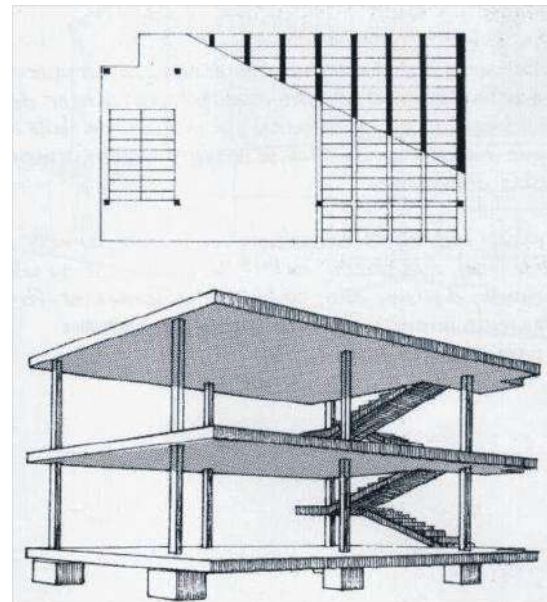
ESTRUCTURA SIMPLE Y PLANTA LIBRE, PROTOTIPO DOM-INO.
